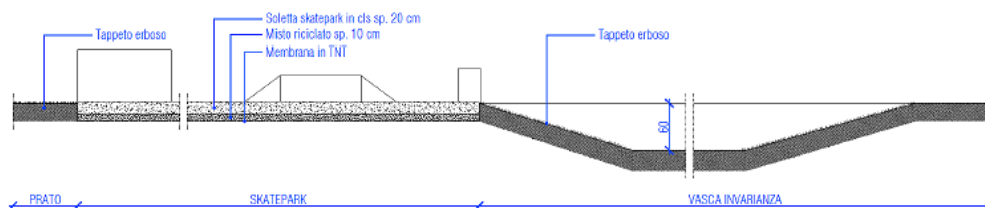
Sezione B-B (Area a prato, Skatepark e vasca di laminazione)
